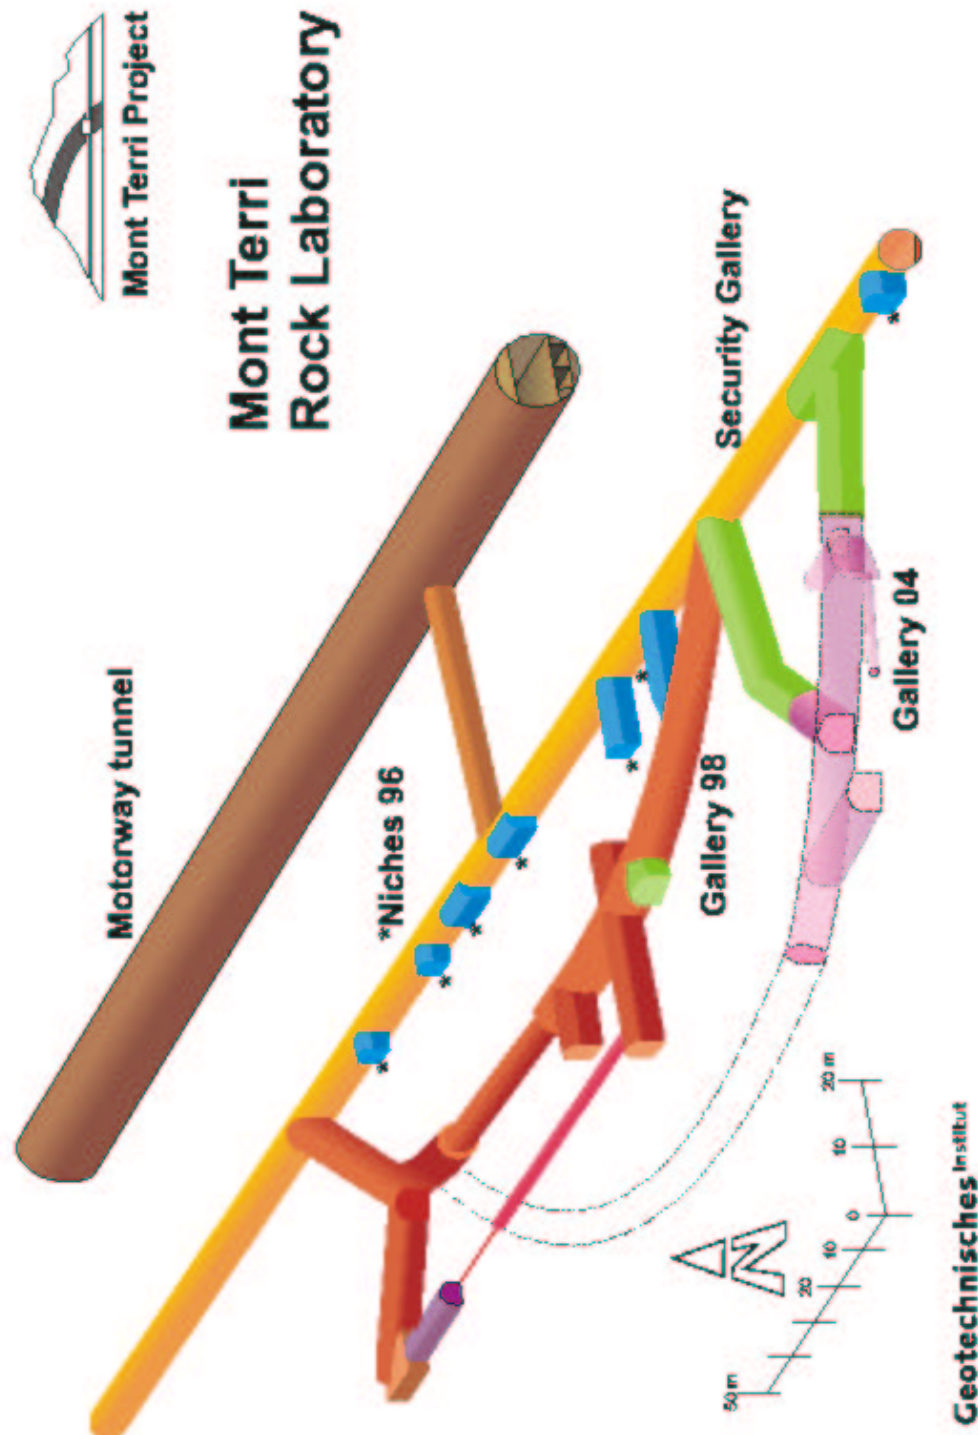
Plan du laboratoire Mont Terri (figure Geotechnical Institute, Switzerland).
